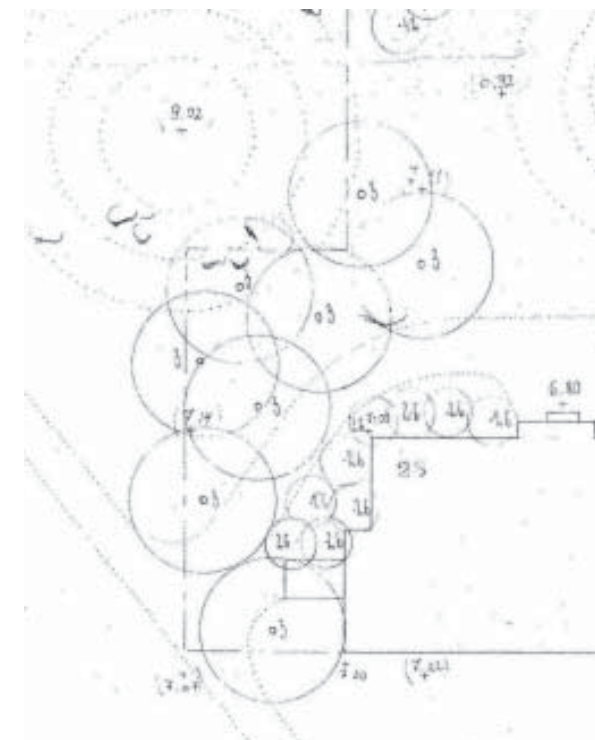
Rikligt bestånd av björk, Handduken. Del av planeringsplan 1943.
